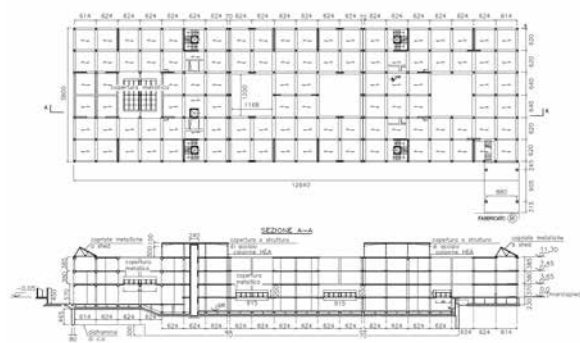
Polo Fibonacci a Pisa. Pianta e sezione dell'edificio C (aule di Informatica).
